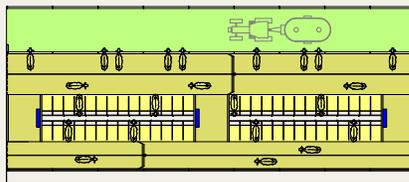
VUE EN PLAN D'UNE AIRE PAILLÉE CALLEBOTIS POUR VACHES LAITIÈRES
